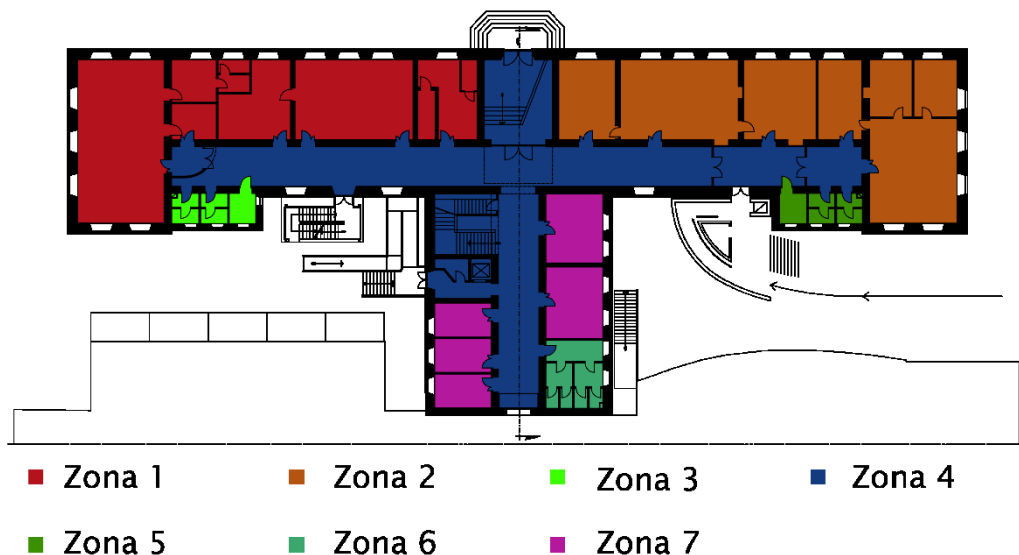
Suddivisione del piano rialzato in zone termiche
